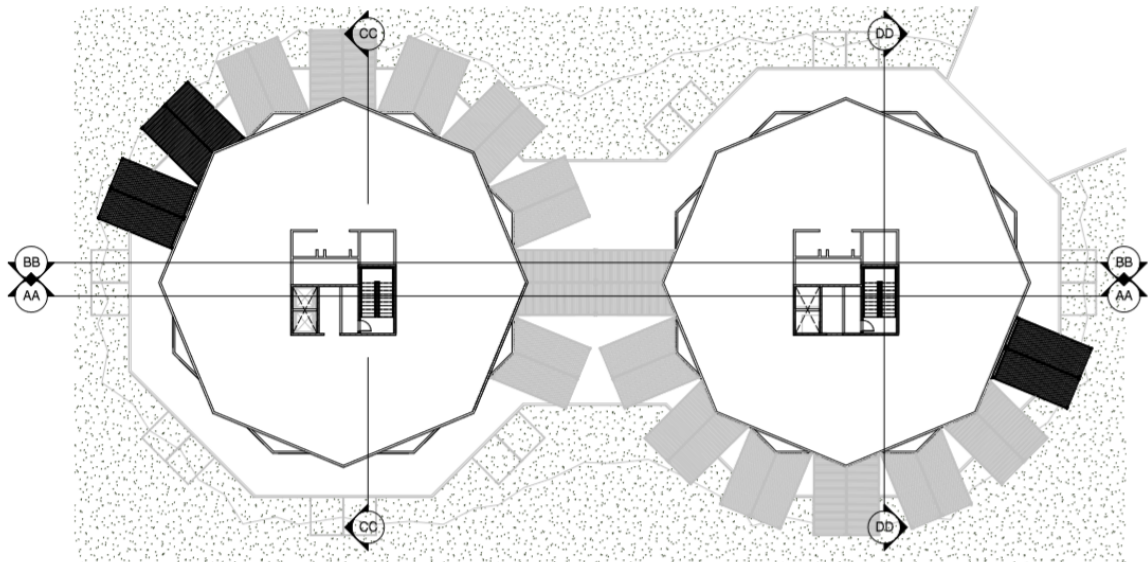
Planta baixa de Coberta do Hotel Fractal.
